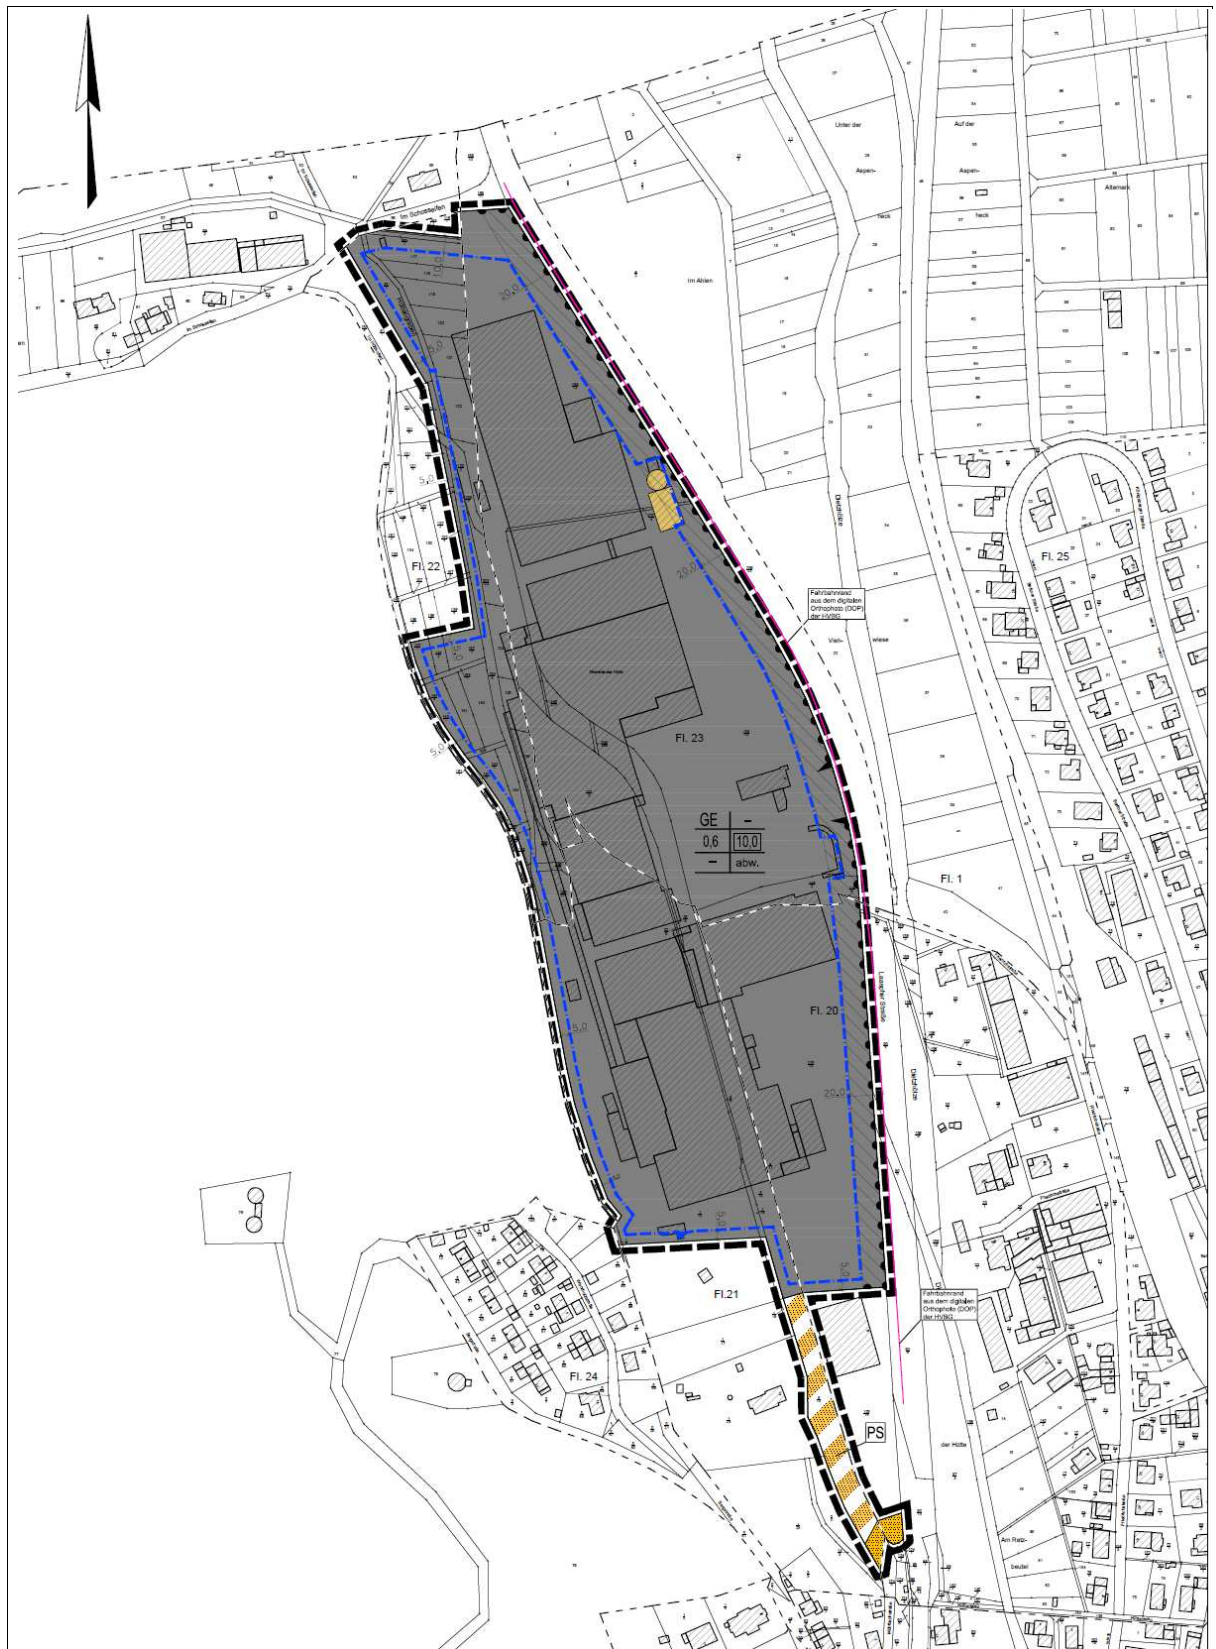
Bebauungsplan „Hütte“, Planteil.
